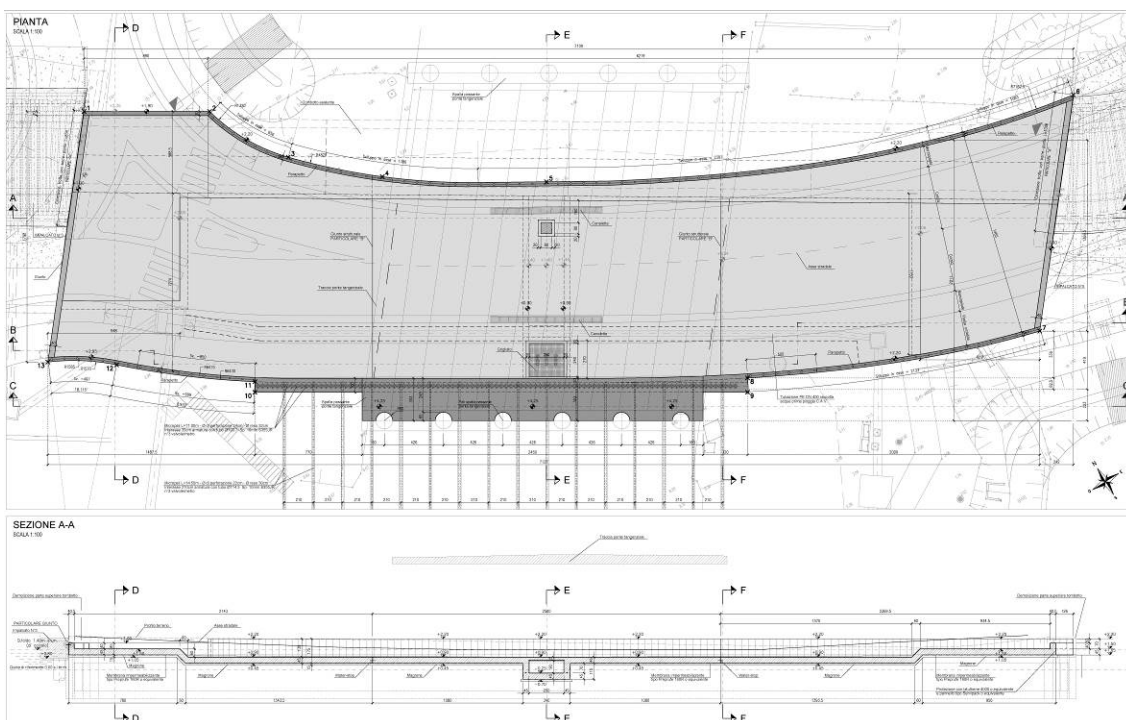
Opera 4 - Sottopasso Tangenziale di Mestre – Pianta e Sezione longitudinale
